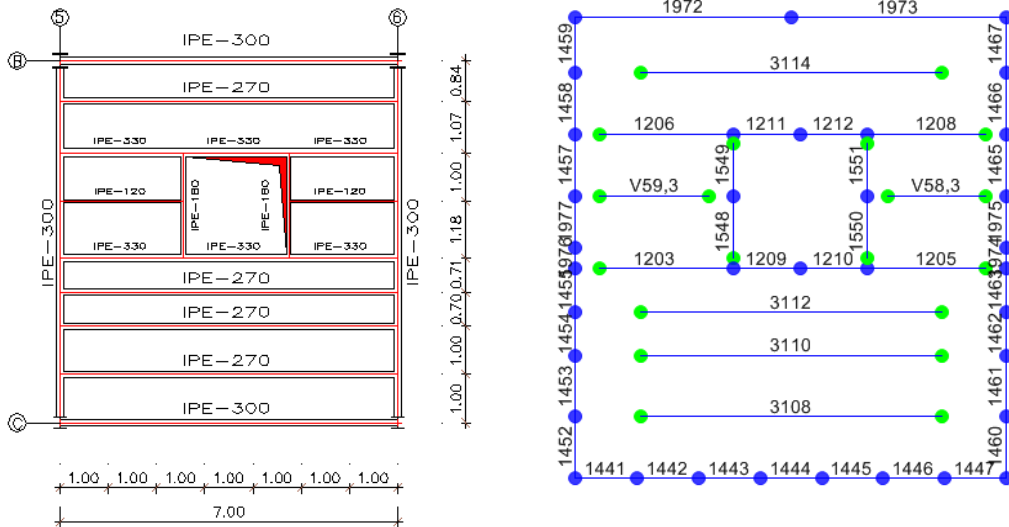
Planta com a Geometria e Identificação das barras do Piso 3 Alinhamentos B e C do "Sap".
